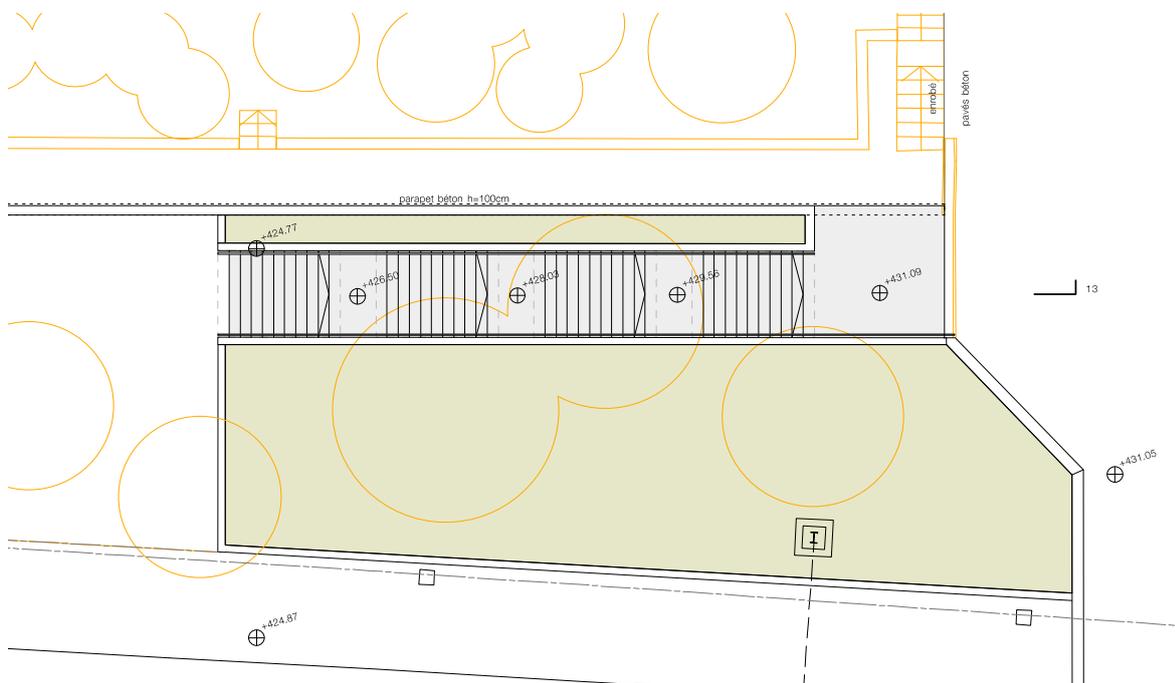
Accès Nord-Est _ vue en plan _ échelle : 1/200
